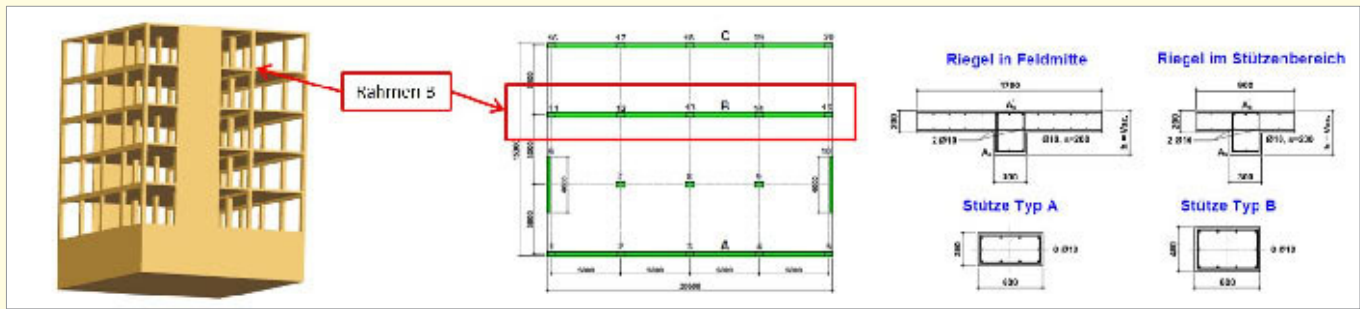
Fünfstöckiges Stahlbetongebäude: Geometrie und Querschnitte [6].
